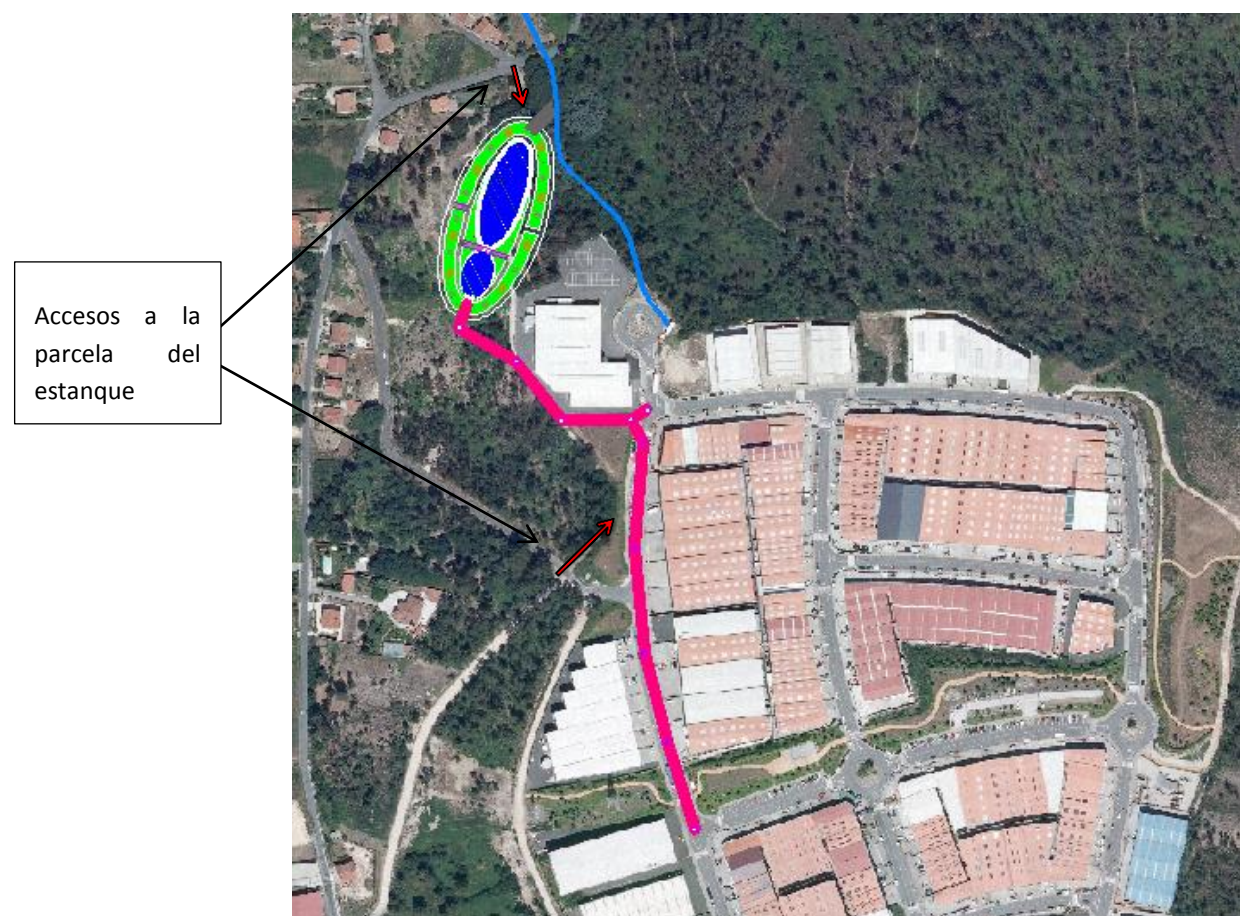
Accesos a estanque y vial por donde discurren las conducciones
